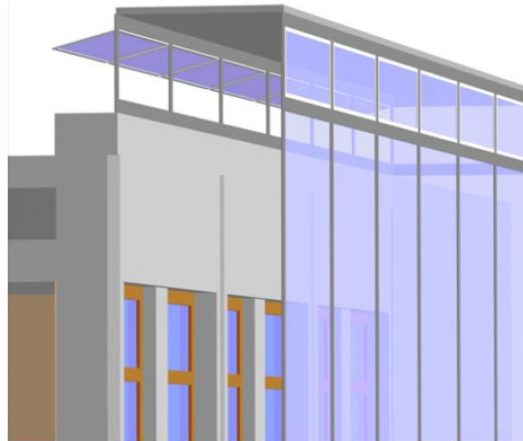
Detalhe da fachada elevada sobre o edifício, com abertura da cavidade frontal e posterior.
